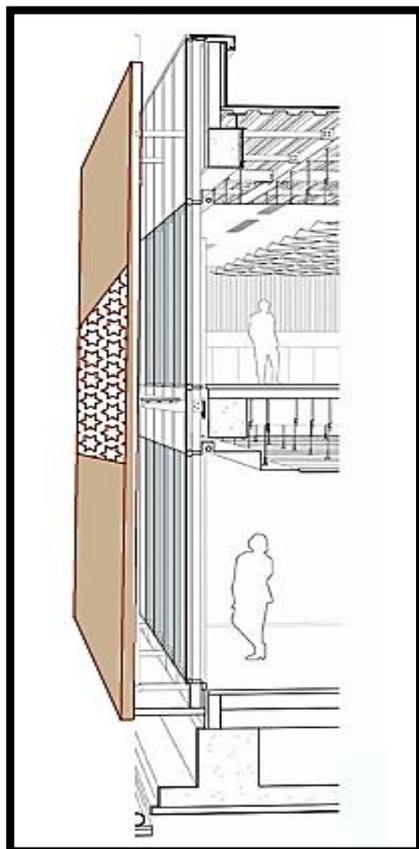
DETAIL D'ACCROCHAGE DES PANNEAUX COMPOSITE SUR LA FAÇADE.
